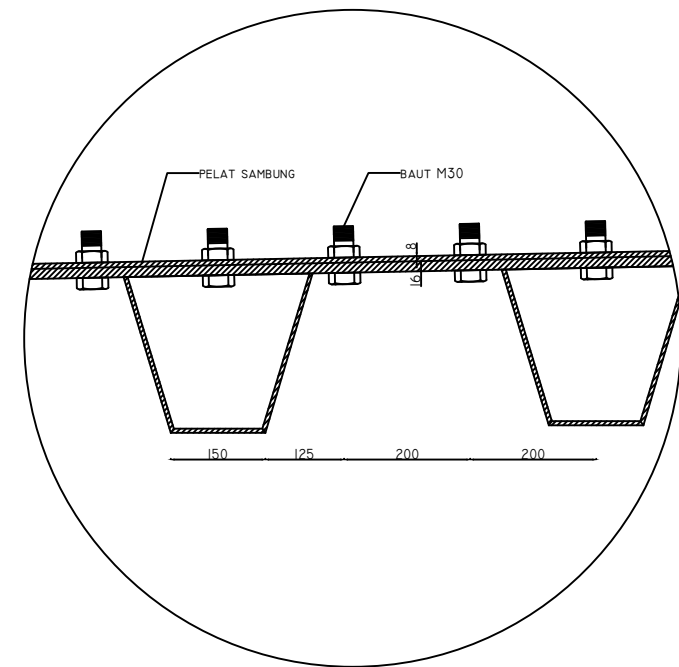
DETAIL LAPISAN PELAT LANTAI KENDARAAN
